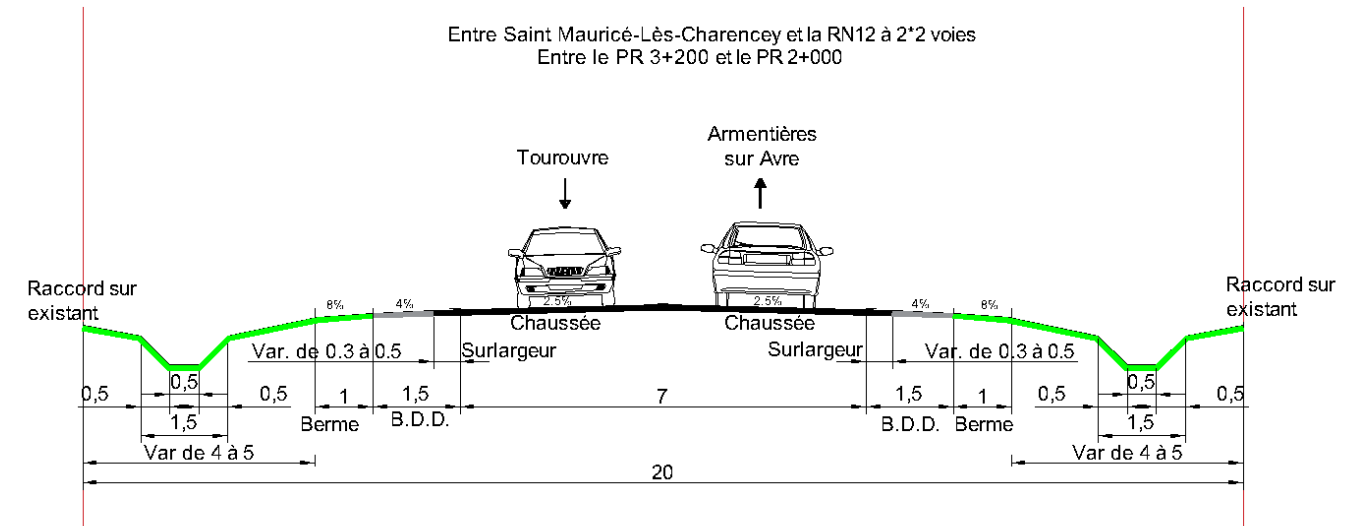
Profils en travers type – section 7 (source: SEGIC)
